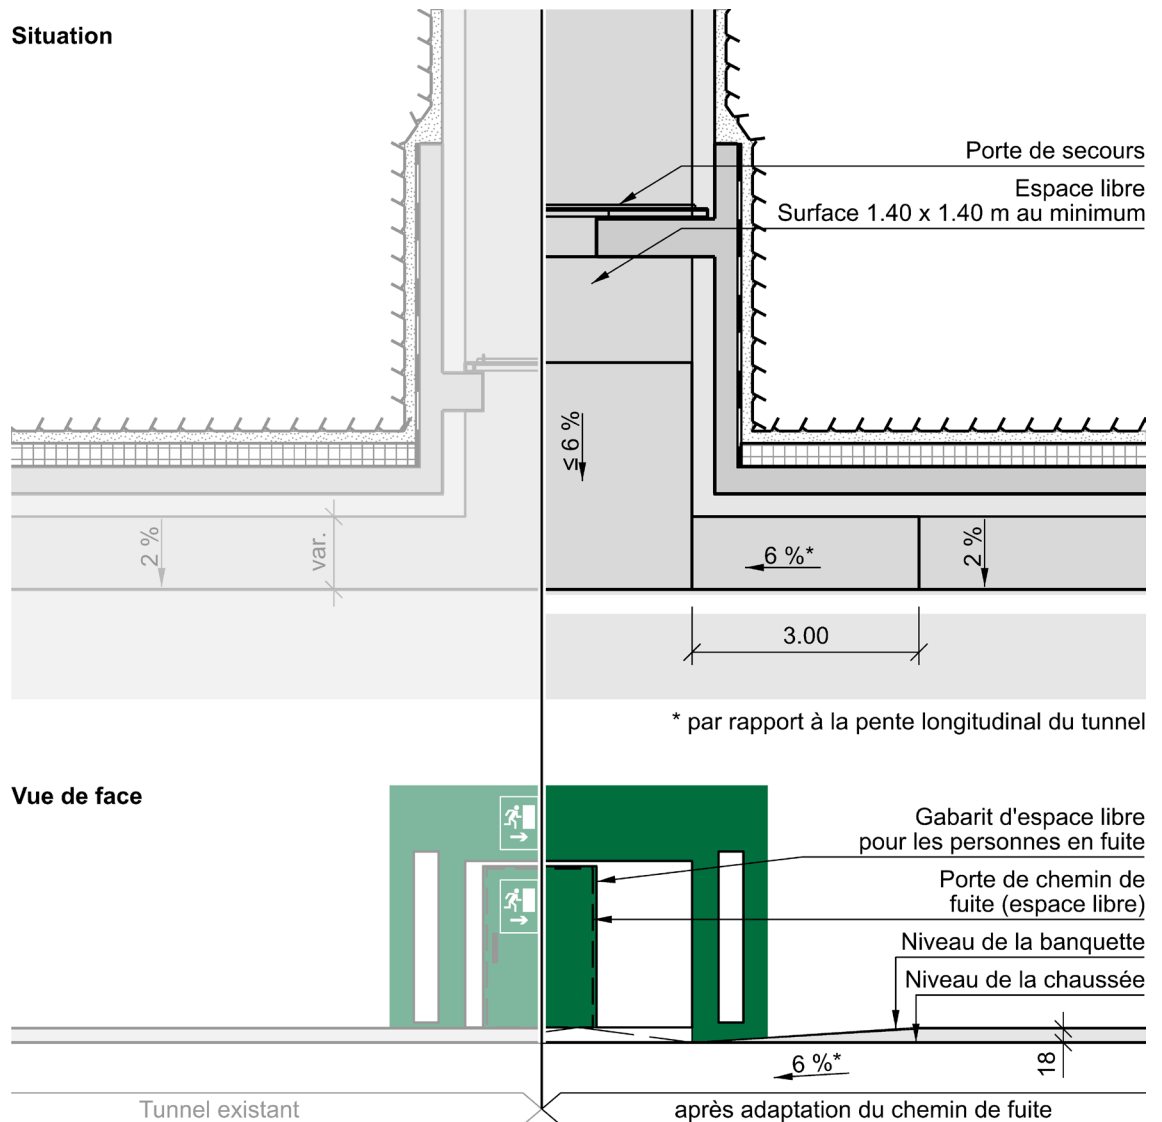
Sortie de secours en Situation et en Vue de face – Adaptation du tunnel existant en abaissant la banquette et en déplaçant la porte de secours dans le sens de la fuite
